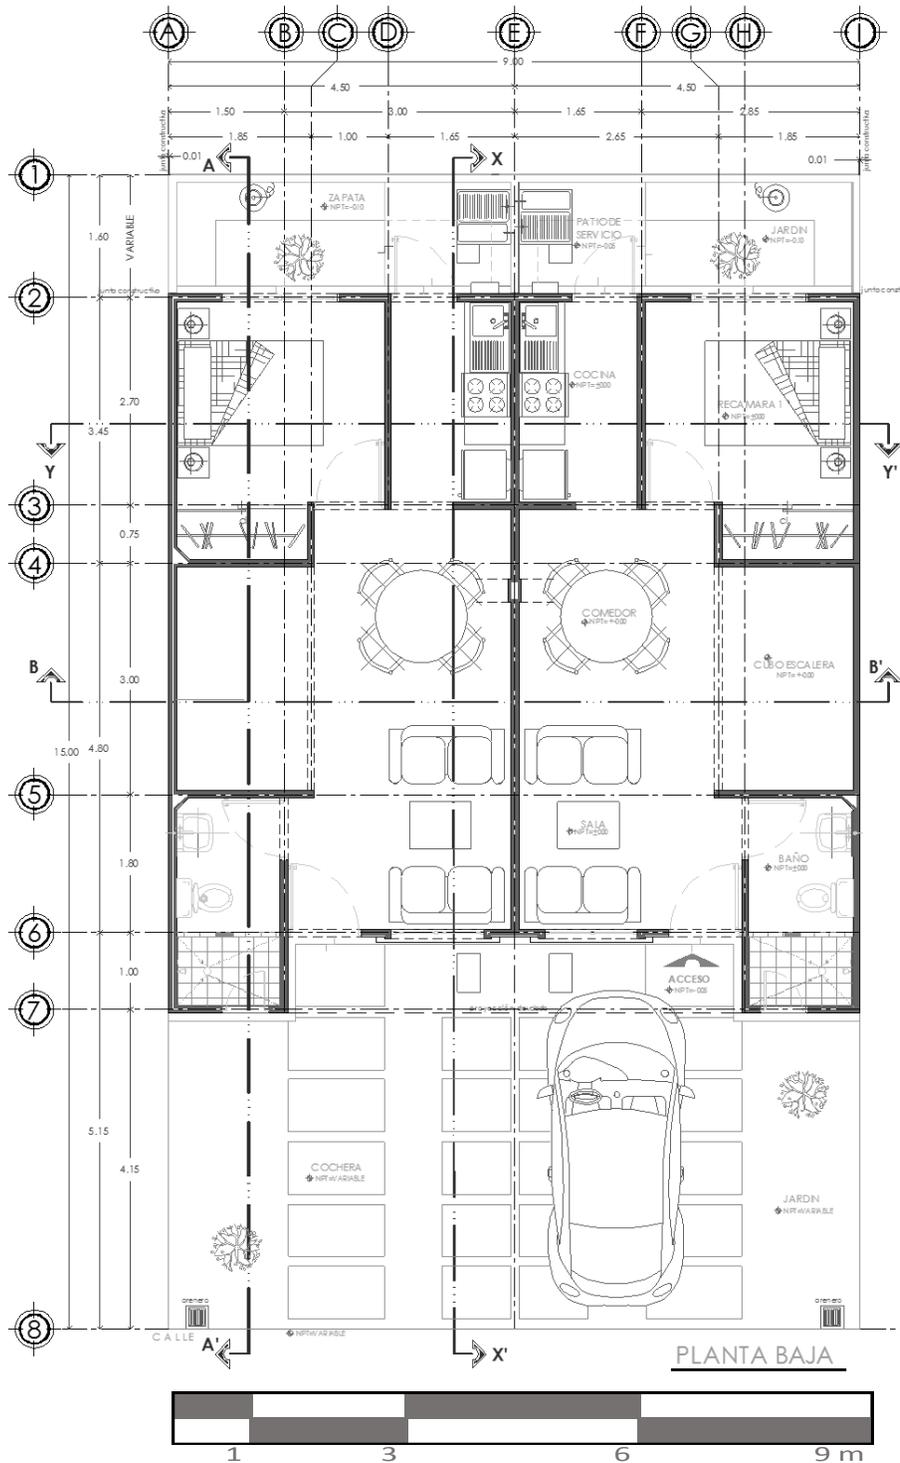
Planta Arquitectónica del Prototipo Fuego 1N-1R
